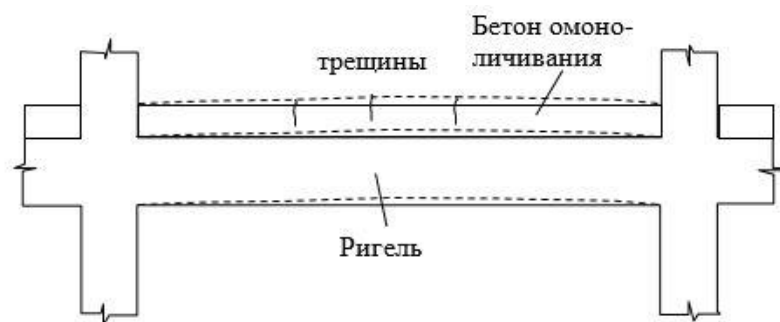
Выгиб перекрытия вследствие набухания бетона ригеля
